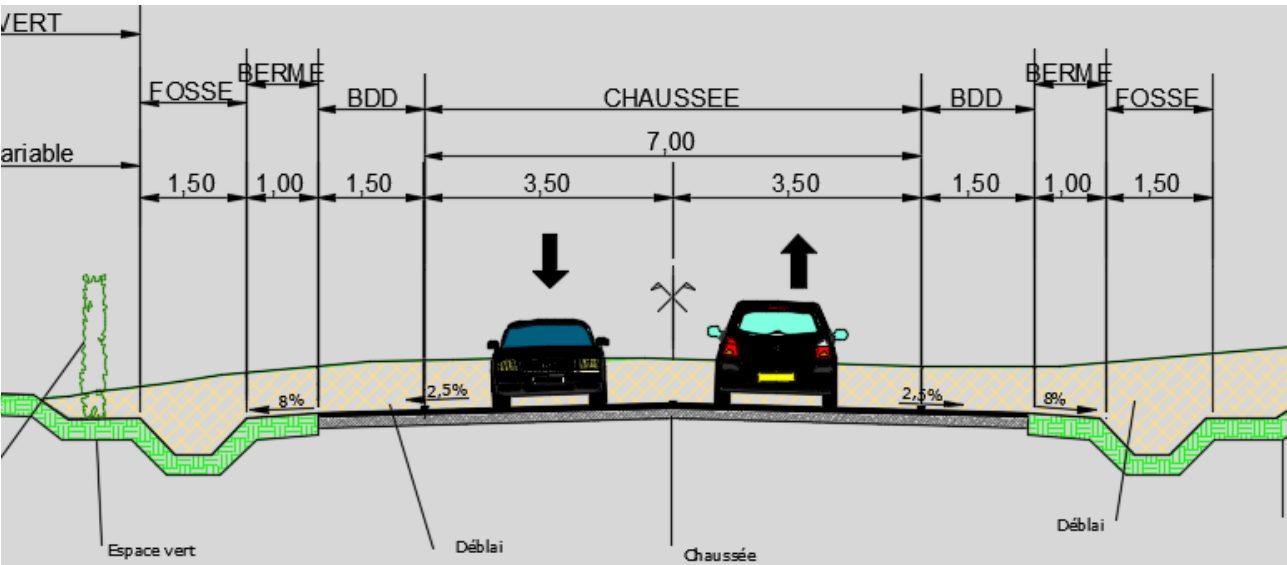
Profil en travers de la RD6 en section à 2 voies
